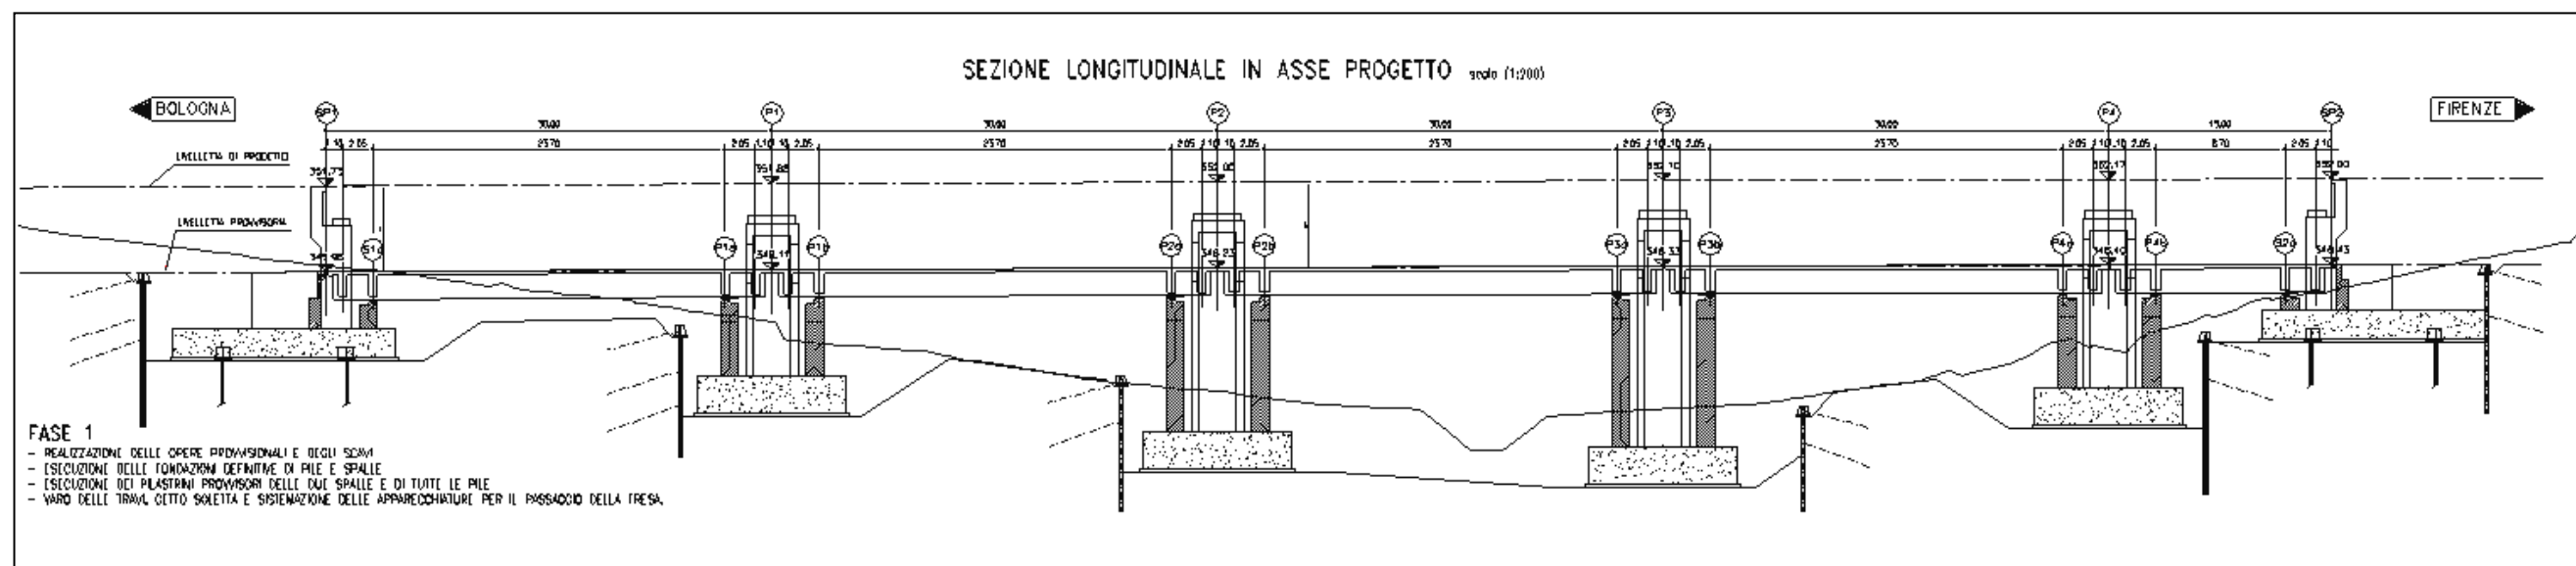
sezione longitudinale del viadotto Baccheraia nella variante approvata, nella fase di cantierizzazione e di attività della fresa
